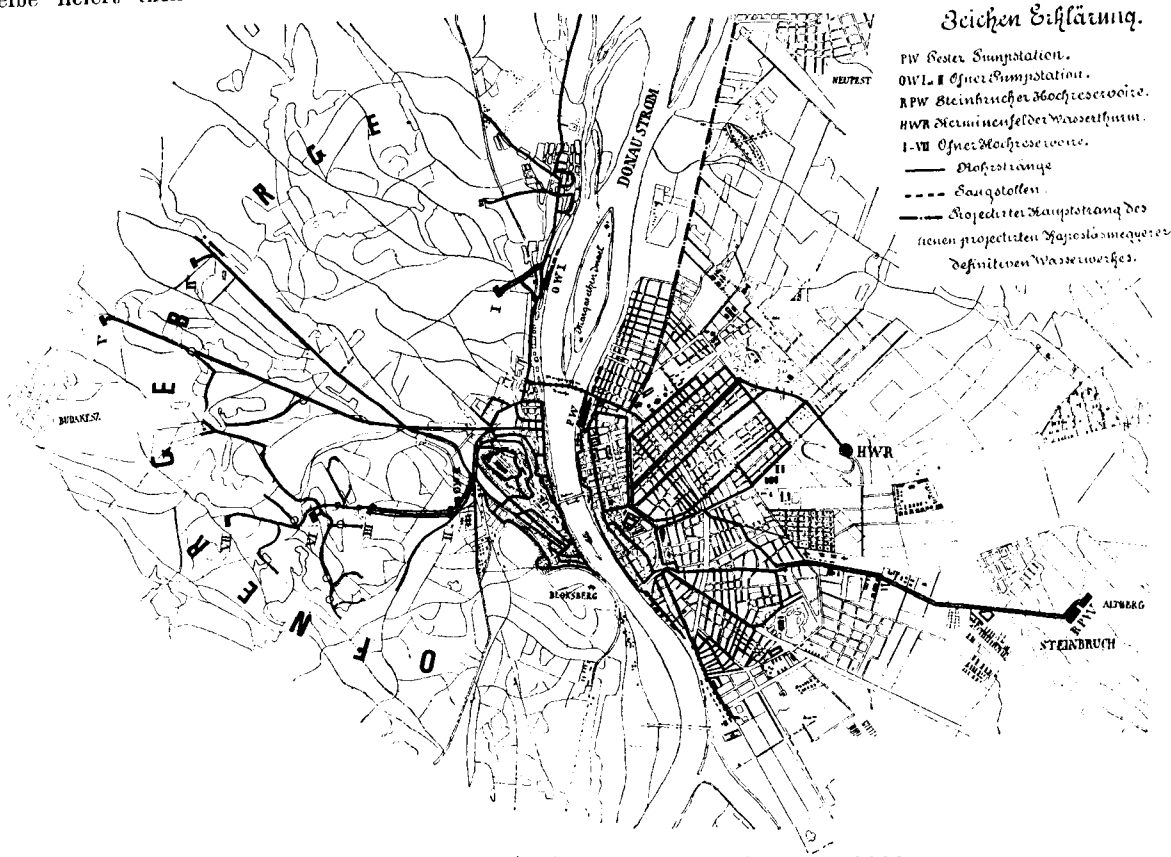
Plan der derzeit bestehenden Wasserleitungsanlagen. 1:150000.
